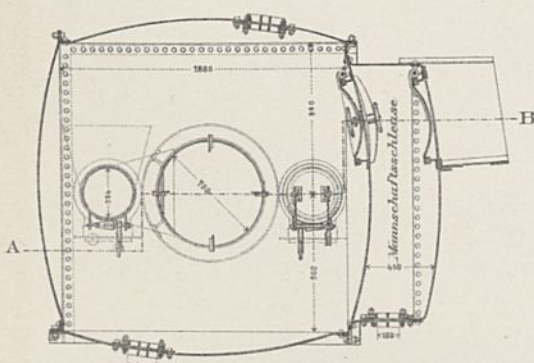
Aufhängevorrichtung für die Senkkasten.
